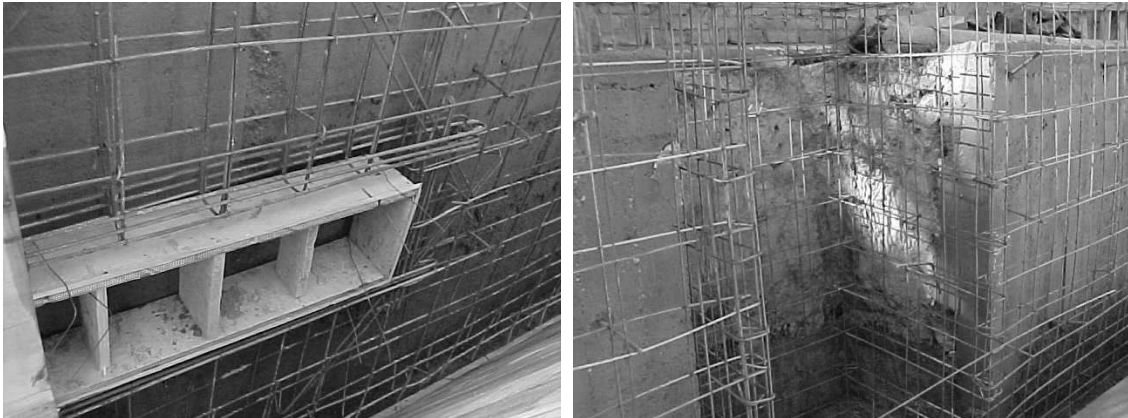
Huecos en tabique perimetral de subsuelo para conexiones. Box ingreso al local inspección
